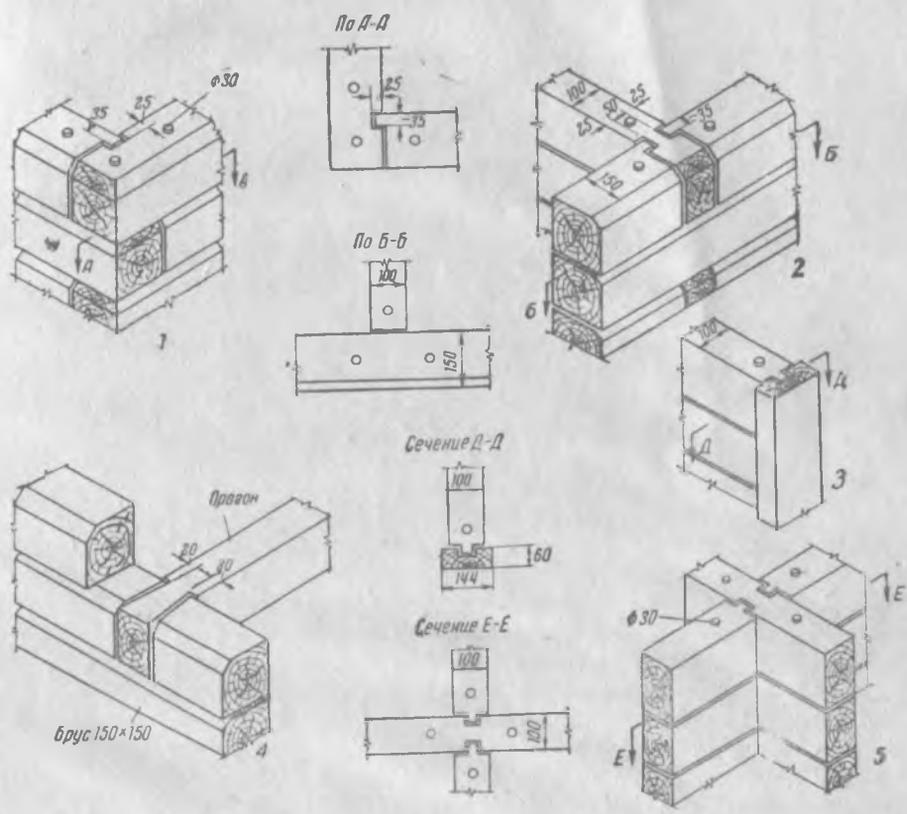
Брусчатые стены с сопряжениями на шипах: 1 — сопряжение наружных стен, 2 — сопряжение наружной и внутренней стены, 3 — проем внутренней стены, 4 — укладка прогона на наружные стены, 5 — пересечение внутренних стен
